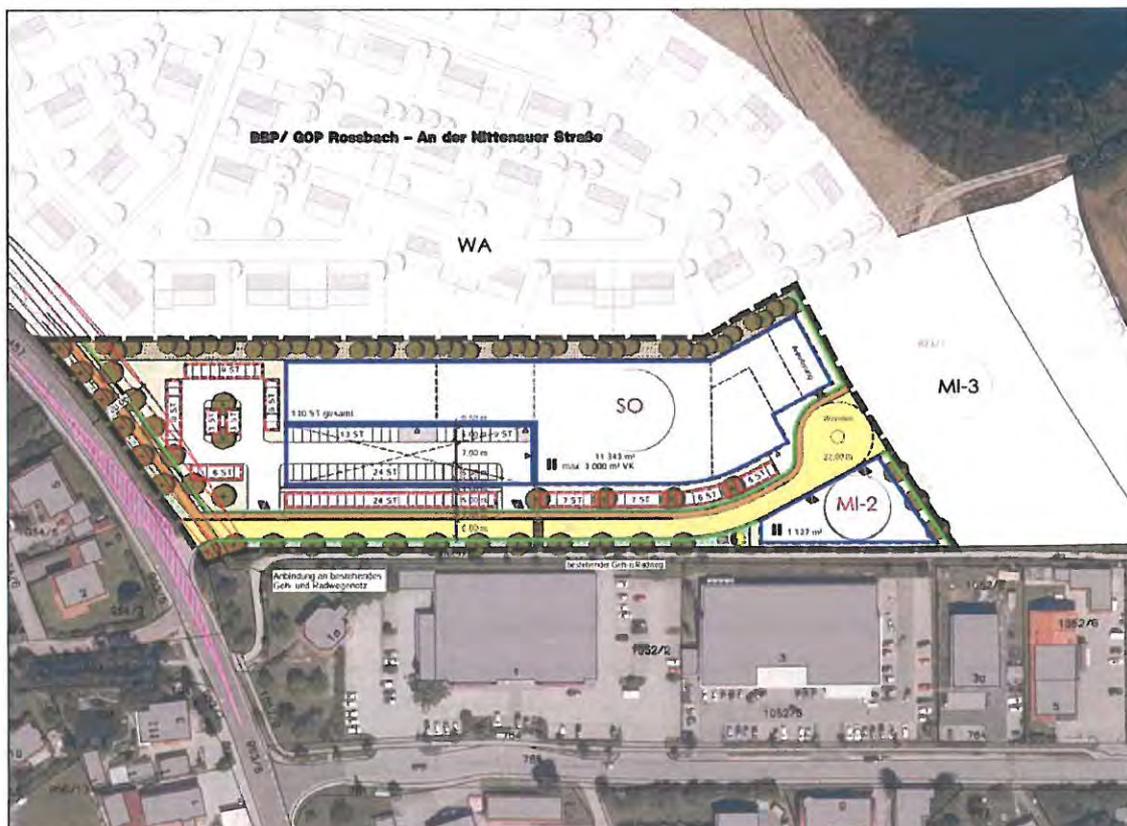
Planzeichnung zur 2. Änderung des BBP "Roßbach – An der Nittenauer Straße" /8/
